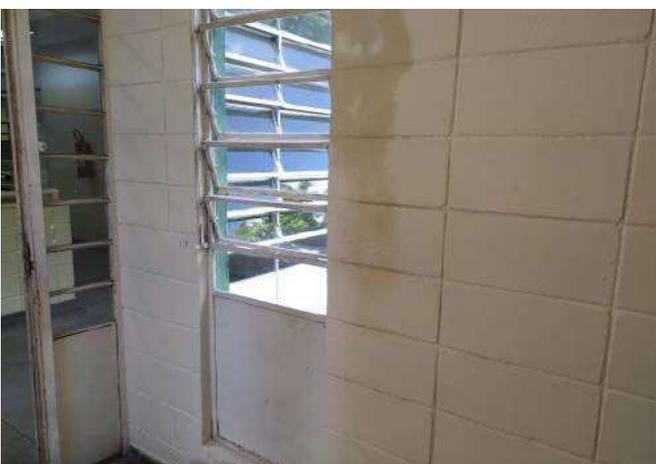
Infiltração aparente no corredor do elevador pavimento superior 01.
